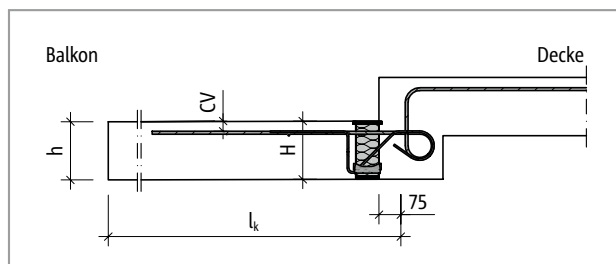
Schöck Isokorb® T Typ K-HV: Statisches System
